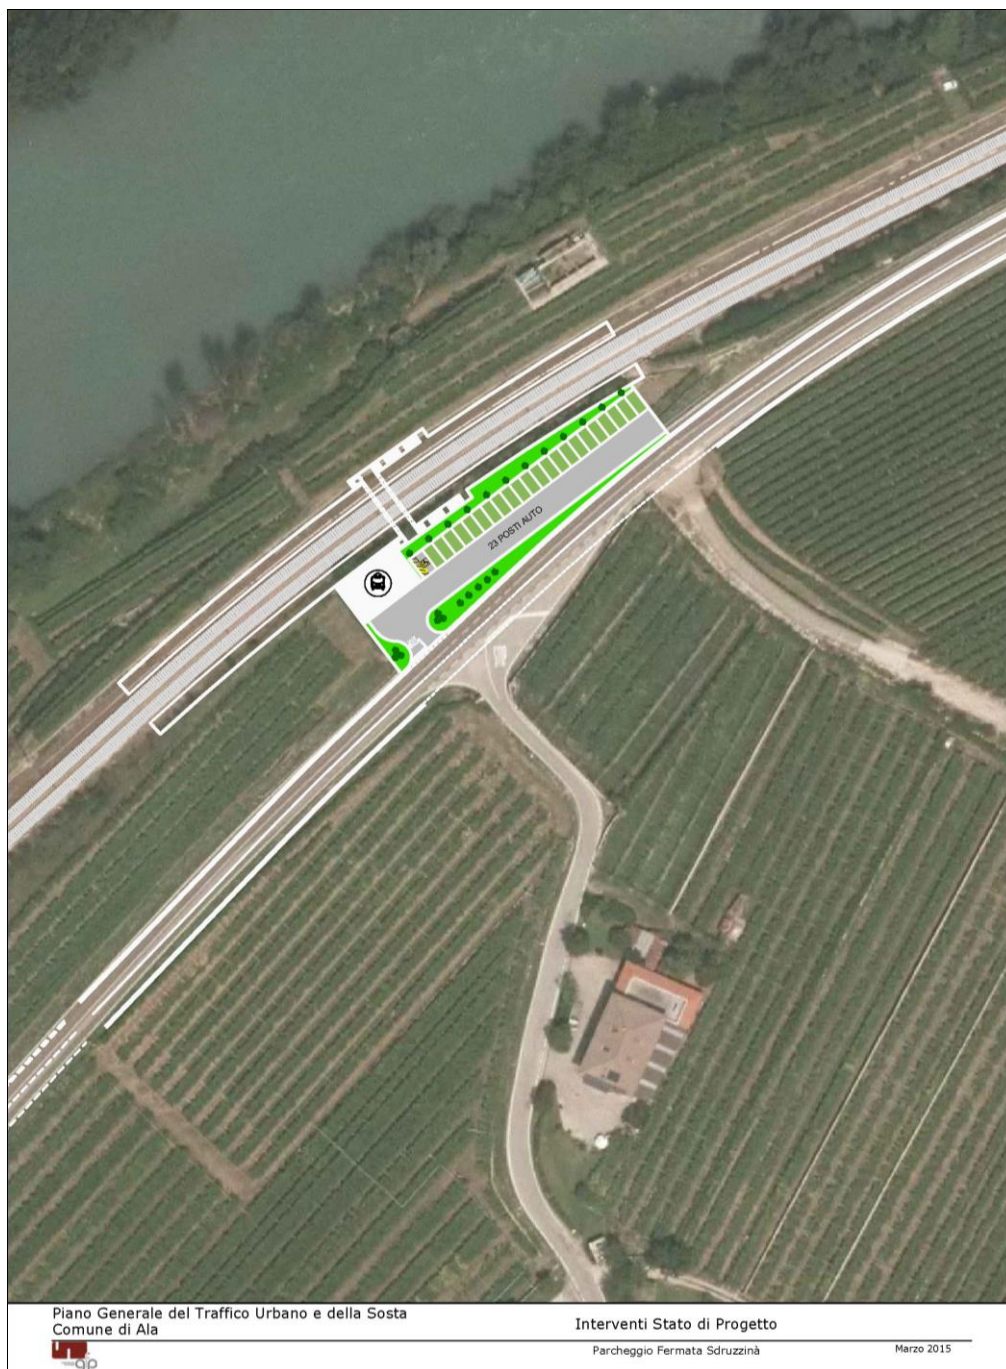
Interventi Stato di Progetto – Lungo Termine – Parcheggio Fermata Sdruzzinà
